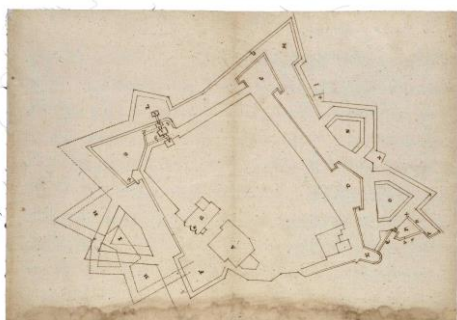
Plano de la fortificación de Fuenterrabía, 1640 (AGS, MPyD, 36, 013)
